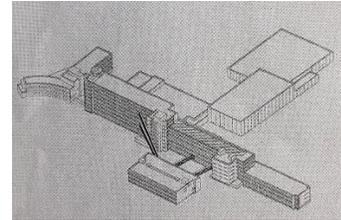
Van Nelle Factory en Rotterdam. (Fuente: Val Warke, Eric Keune y Andrea Simitch, 2017)
